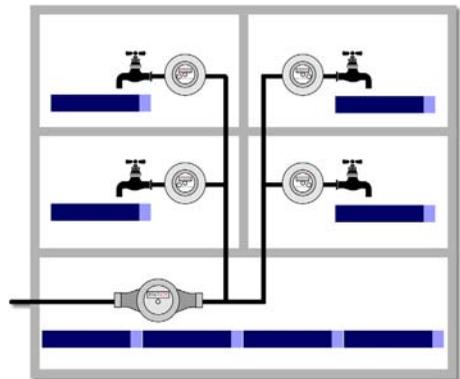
Jeder Zapfvorgang (dunkel) führt auch zu einem kaum erfassbaren Nachlauf (hell) des Zählers. Am Hauptzähler führt aber jede Zapfung im Haus zu einem Nachlauf und damit zu einer messbaren Menge.
